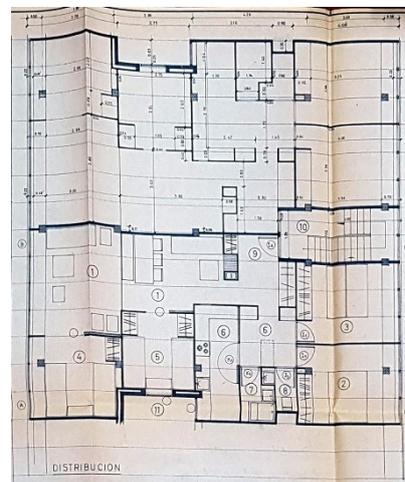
Planta Distribución B-3-4. 1964. Fuente: Archivo Municipal da Coruña
